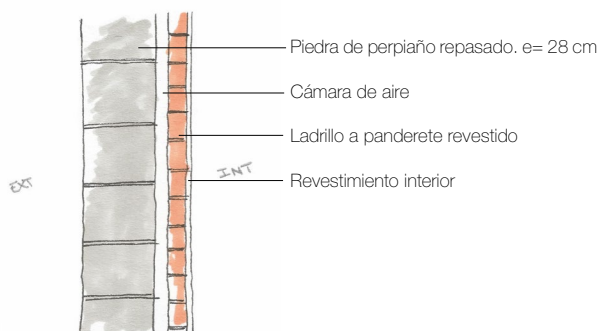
Sección de pared frontal (Sur) y trasera (Norte) (autoría propia).
